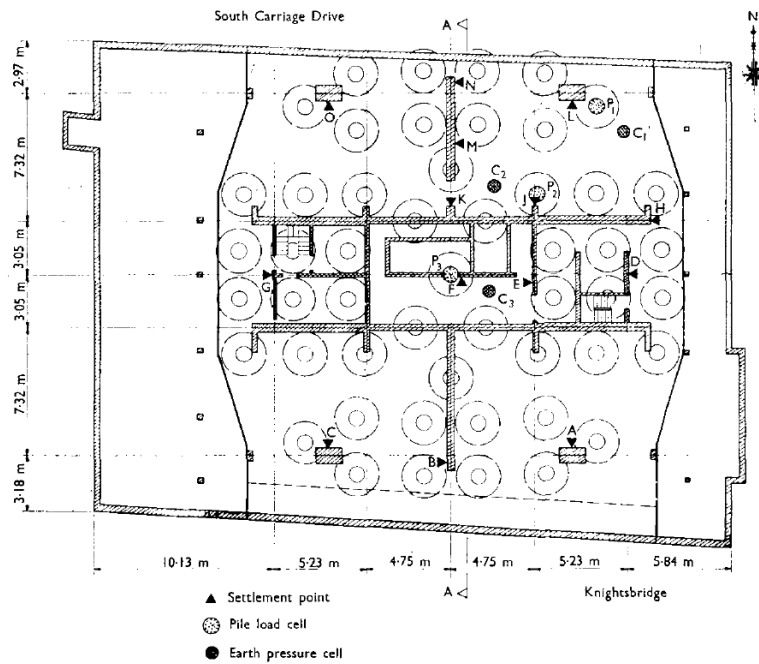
Hyde Park Cavalry Barracks - Plano Sótano Torre (Hooper, 1973)
